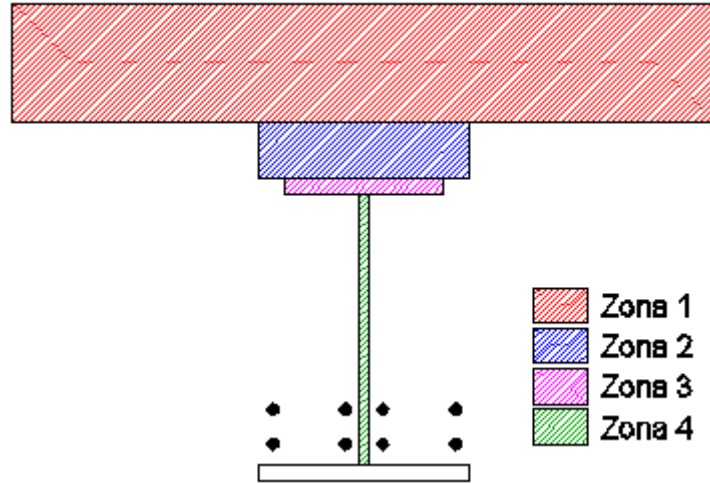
Localizações do eixo neutro para secções com perfil metálico envolvido em betão (M+).
